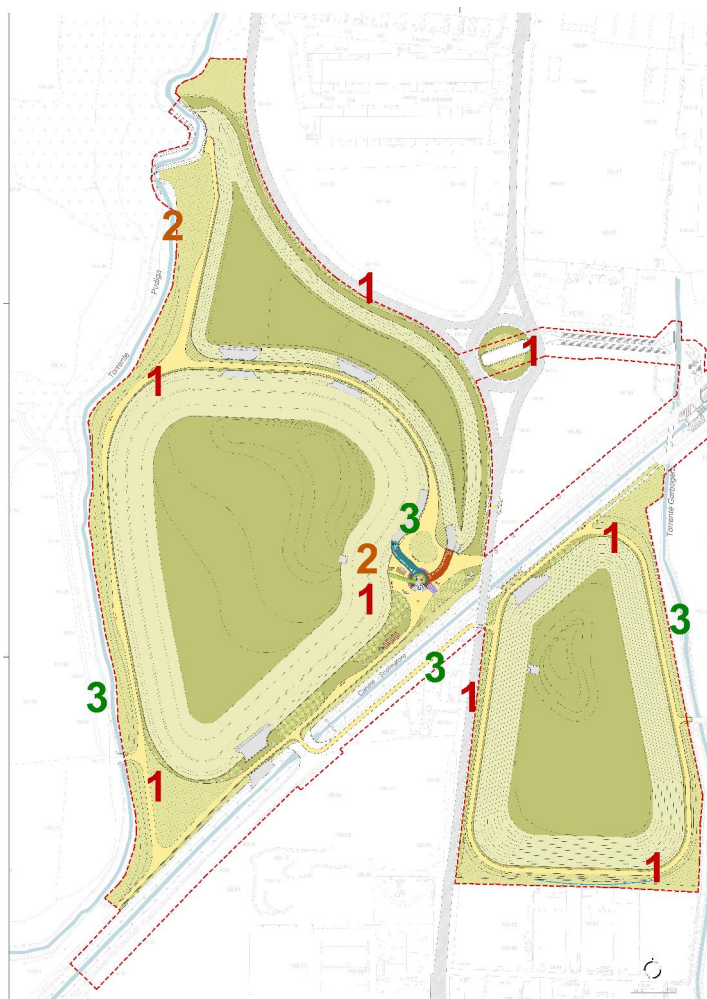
Progetto definitivo di valorizzazione paesaggistica: interventi
